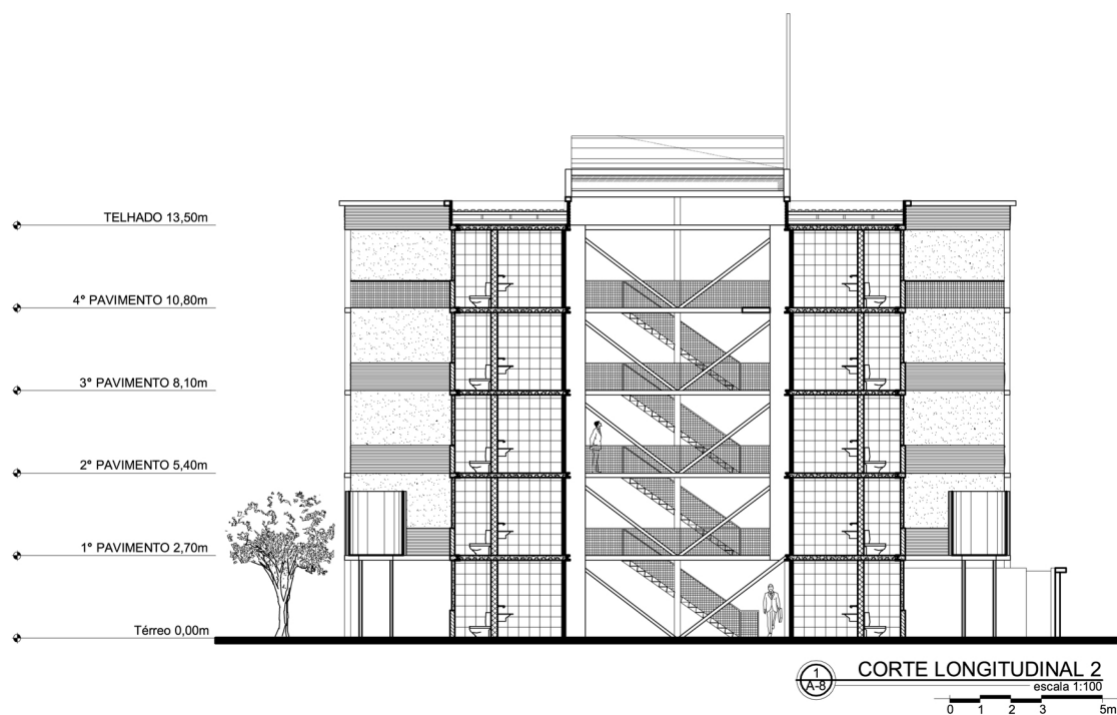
Corte longitudinal 2. Fonte: Arquivo do autor
